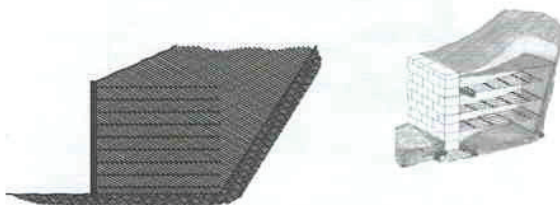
Estructura en Suelo reforzado con refuerzo Metálico
